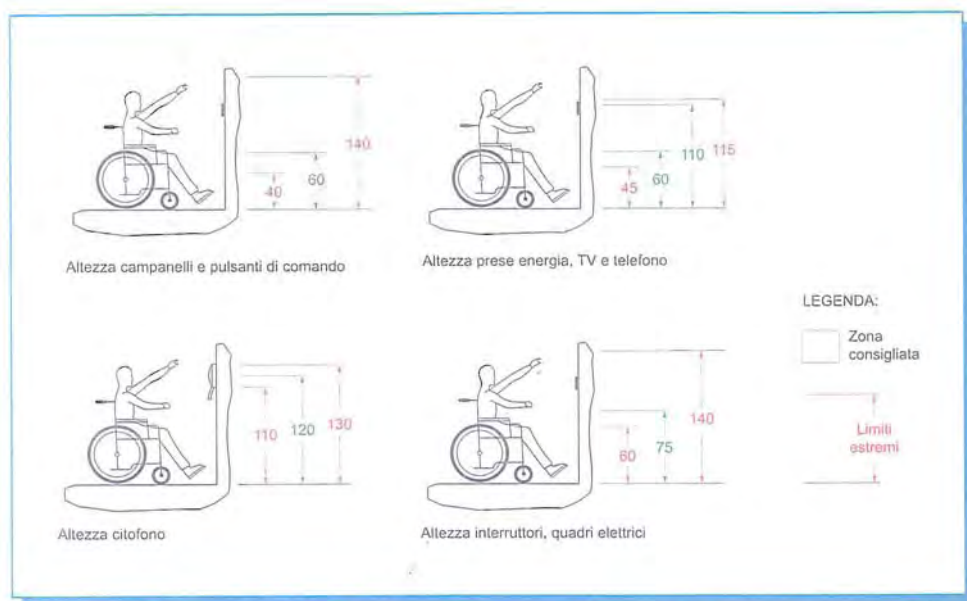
Disposizione delle apparecchiature elettriche ai fini dell'eliminazione delle barriere architettoniche (quote in centimetri).
